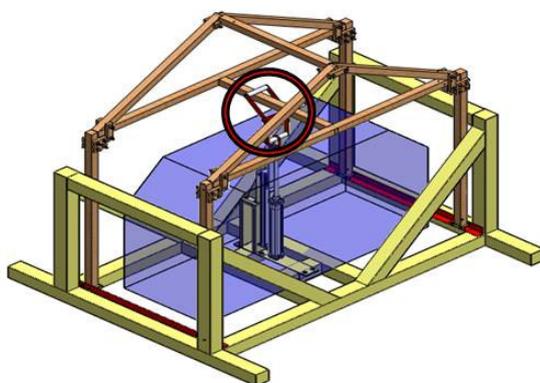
Esboço da montagem da estrutura do pórtico na bancada de ensaio.
